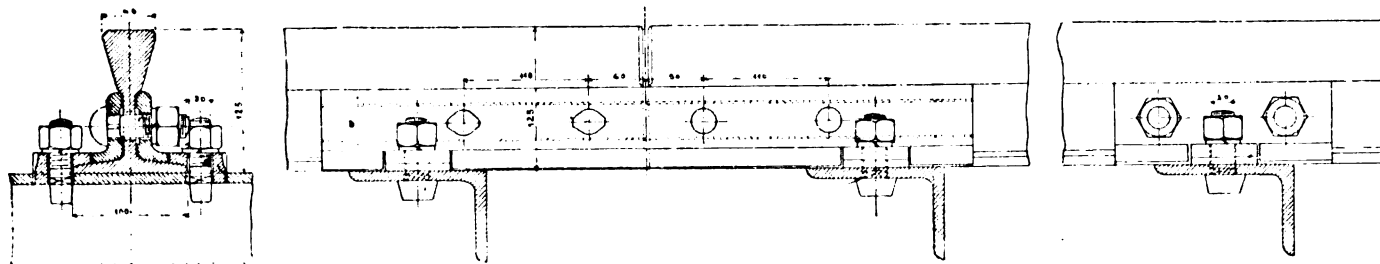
Funicolare al Campo dei Fiori. - Sezione e vista del giunto e vista di una stecca intermedia.
